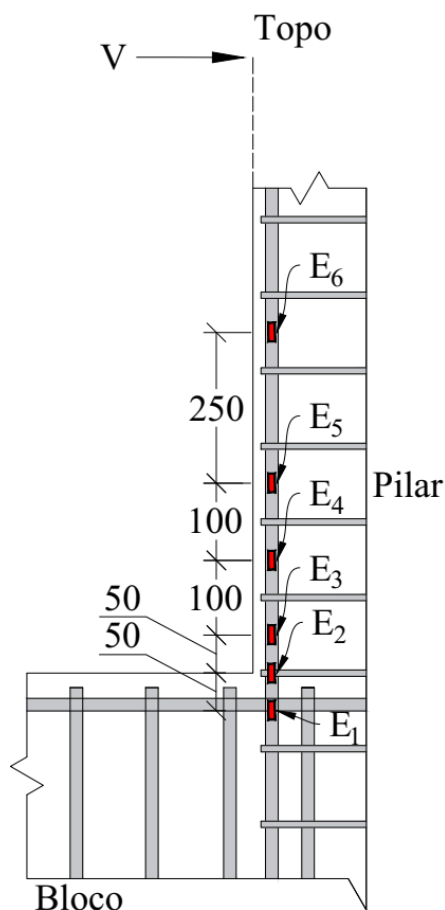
Detalhe dos pontos de instrumentação da armadura longitudinal
